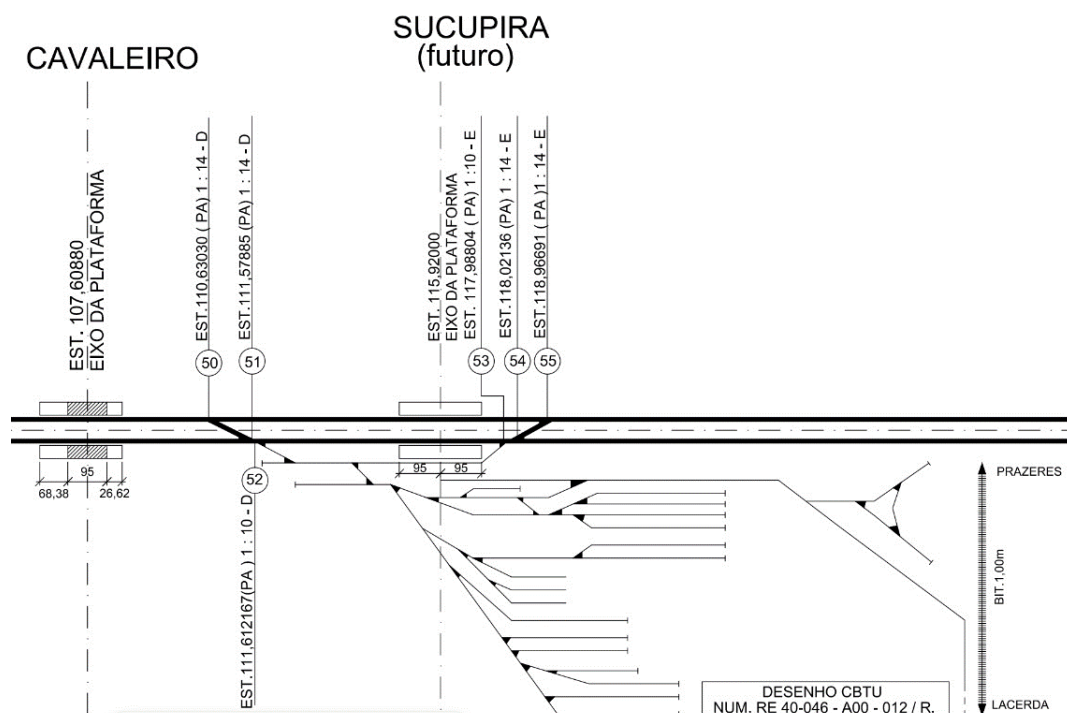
Plano Esquemático de Vias do Pátio de Cavaleiro
